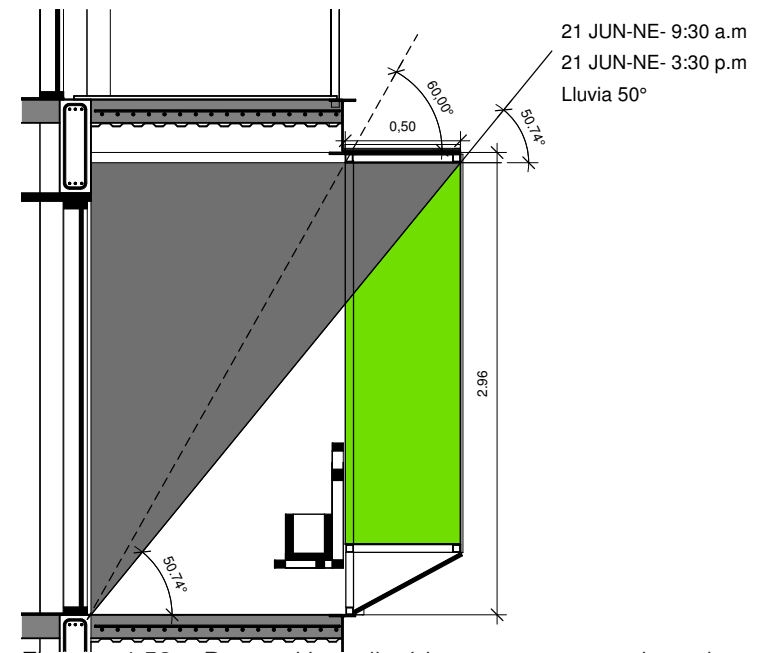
Protección climática vetanas periscopicas fachadas Este-Oeste. Fuente propia.
